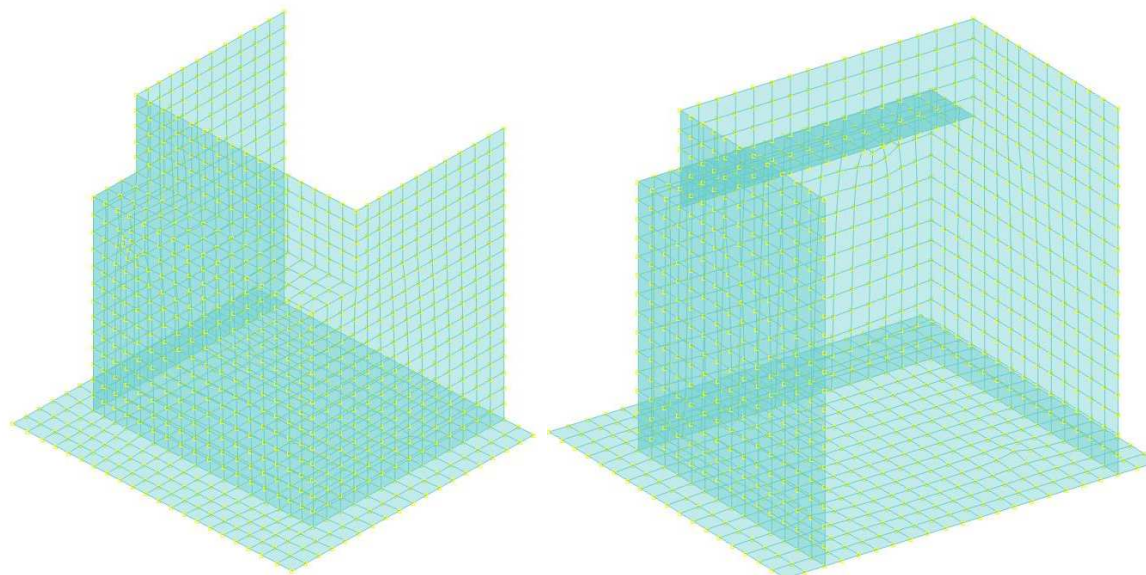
Modello con platea - Vista tridimensionale fronte e posteriore - Spalla tipo
